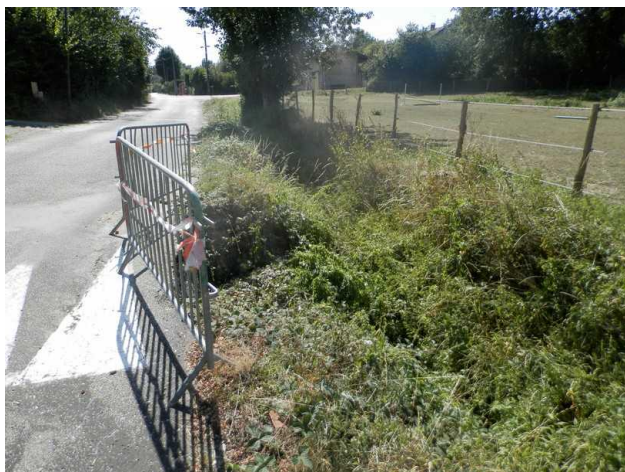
Érosion et ravinement du fossé au droit de la Montée du Pillard.
